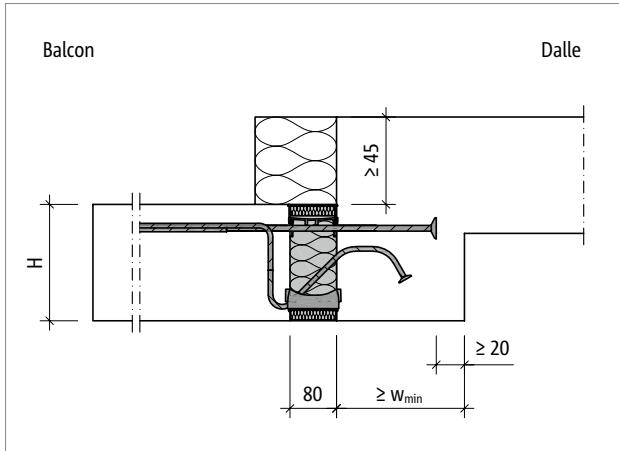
Schöck Isokorb® T type K-U : balcon avec décalage vers le bas et isolation extérieure
